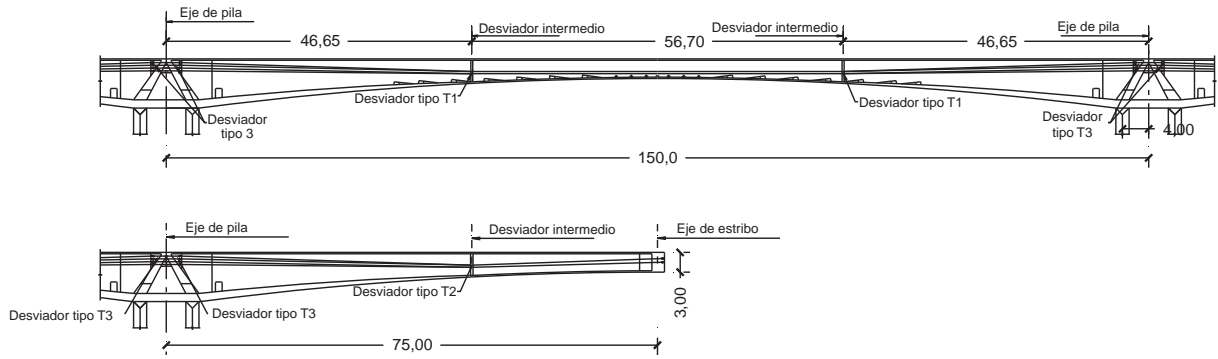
Trazado del pretensado de refuerzo exterior. Alzado longitudinal.
